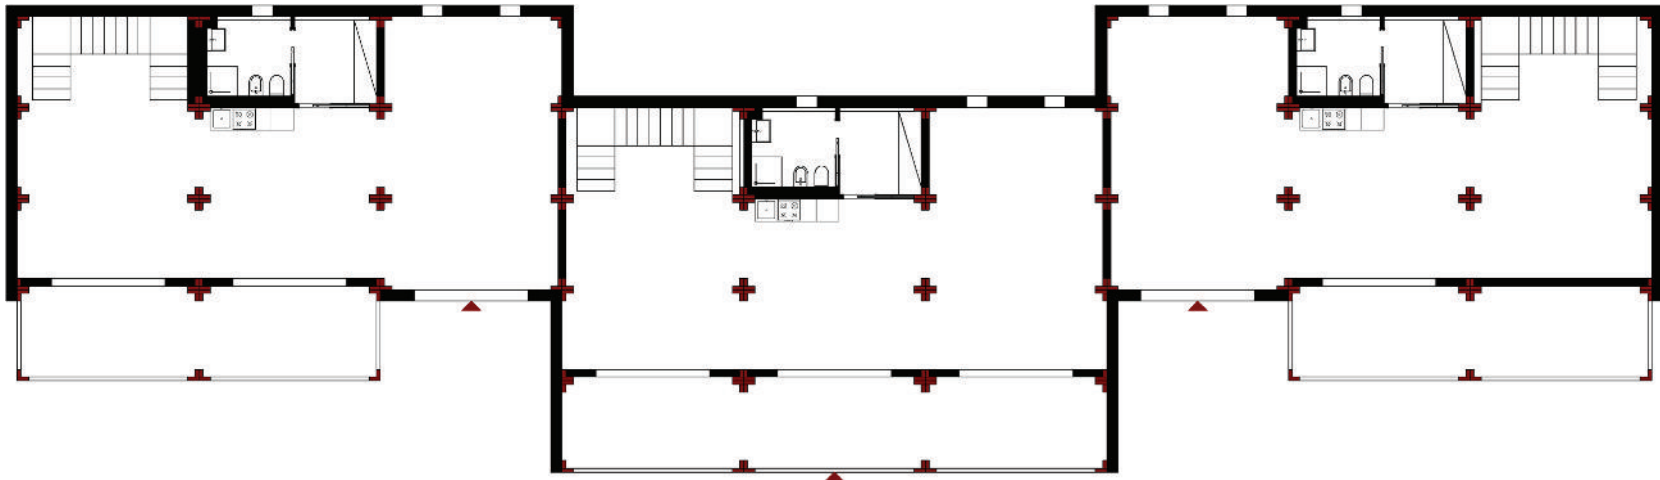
\_ Ipotesi di edifici a schiera \_ Planimetria piano terra \_ Scala 1:200
